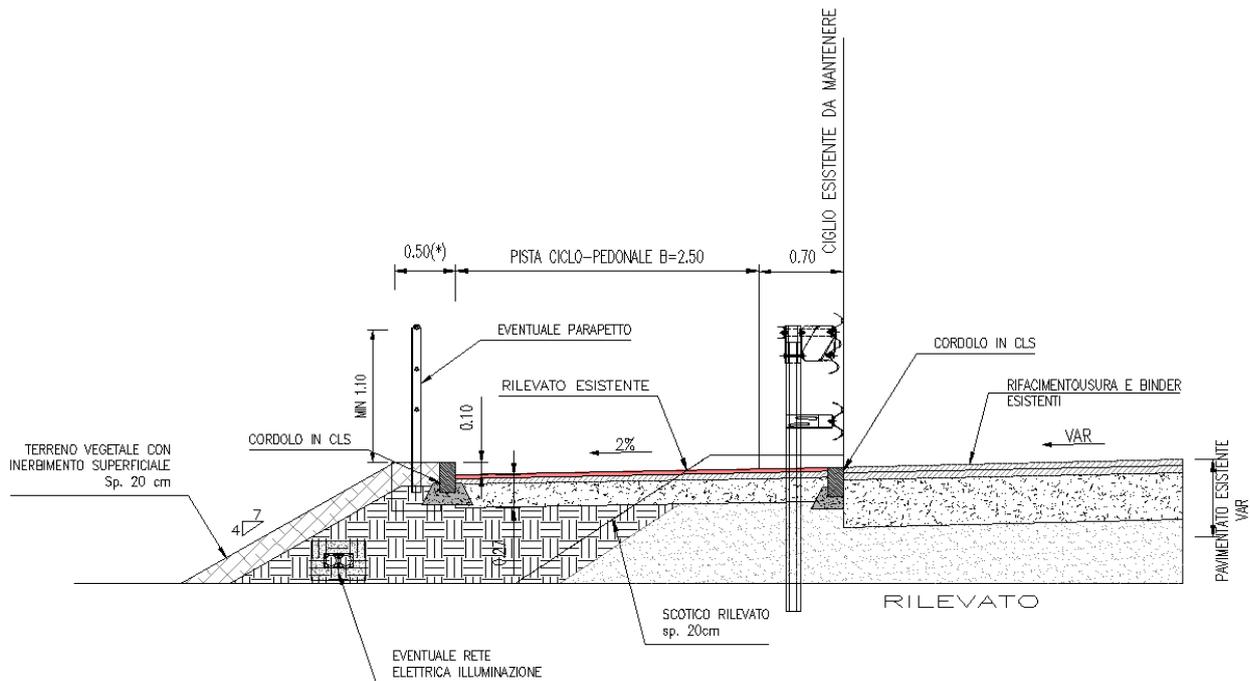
Sezione tipo di progetto pista ciclabile in affiancamento alla SP204
